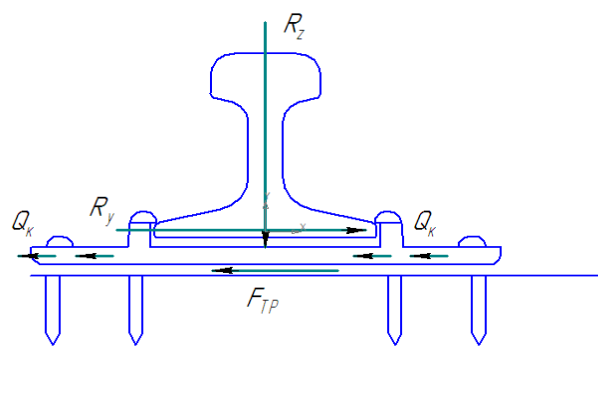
Схема завантаження вузла скріплення ДО поперечним навантаженням
